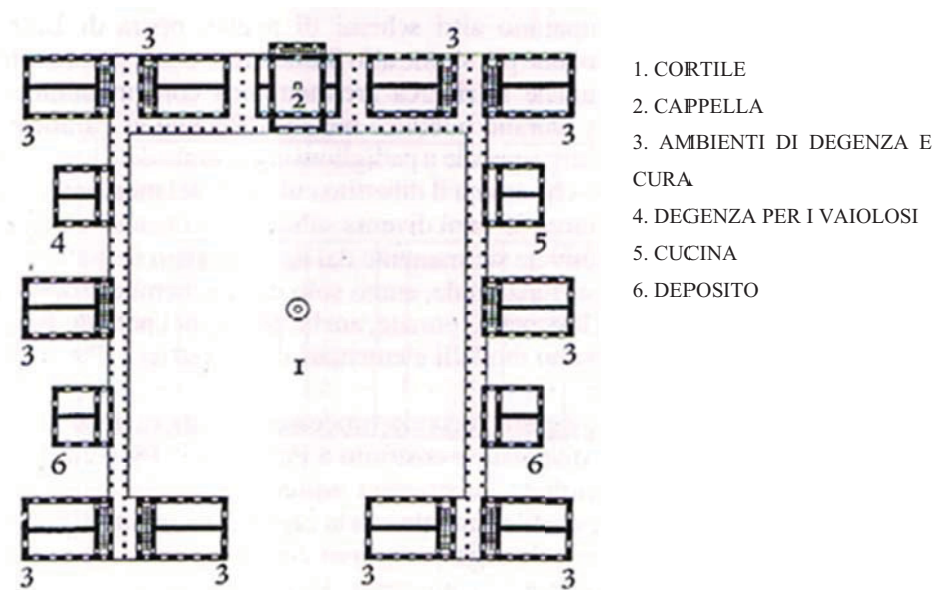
Pianta del Royal Naval Hospital, Plymouth, Inghilterra, 1756-64
